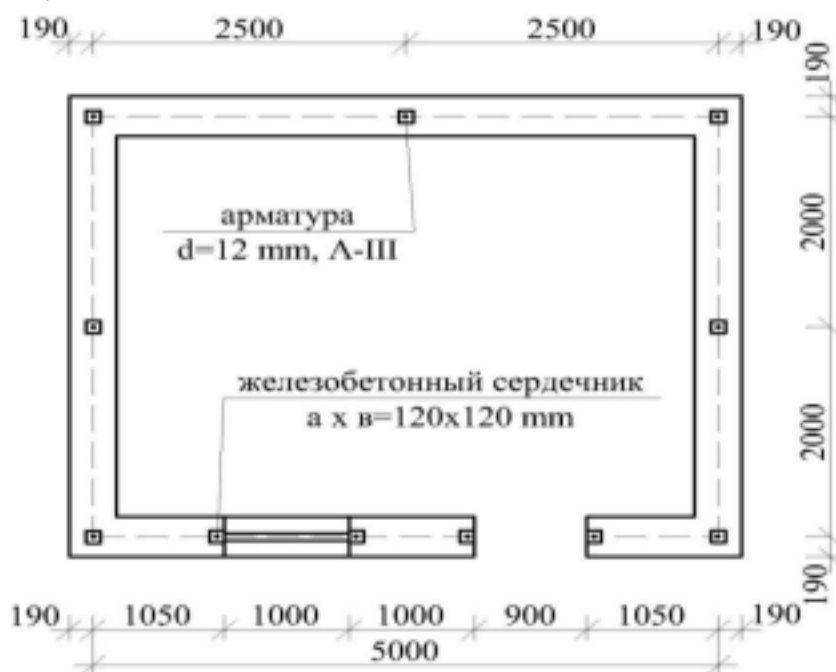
План стен одноэтажного дома из сырцового кирпича, усиленного
